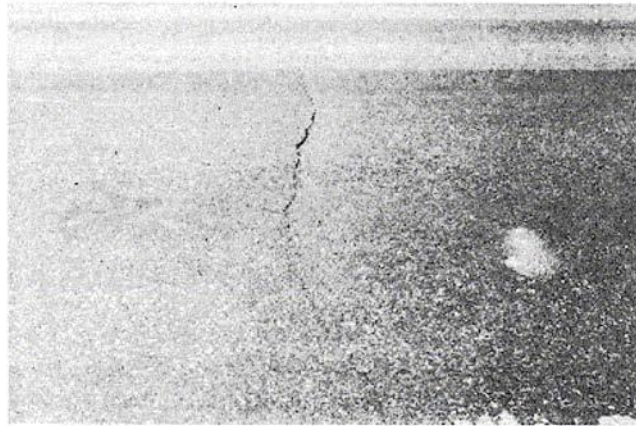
a. Agrietamiento Longitudinal y transversal Baja-severidad.
